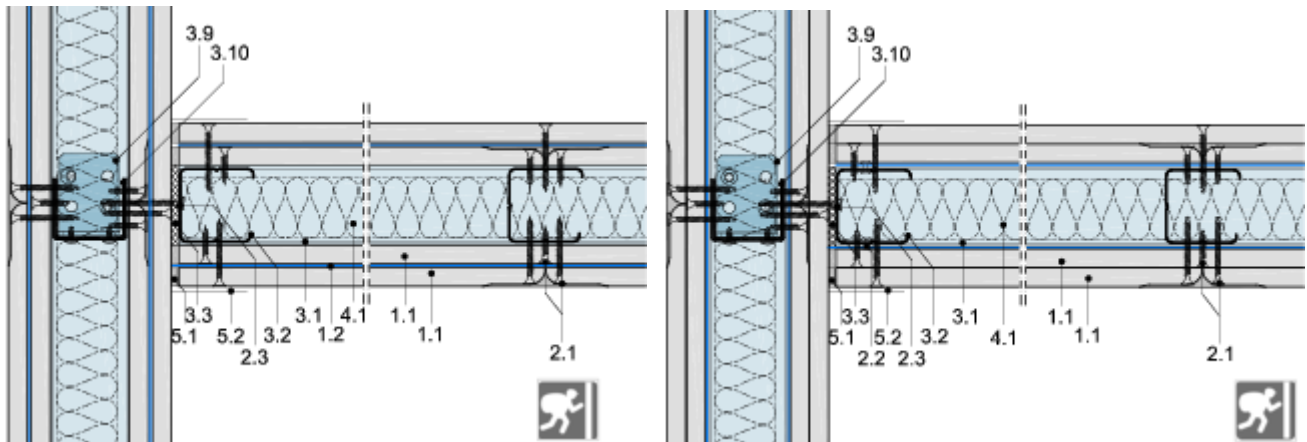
Wanddecke Doppelständerwand RC 2 mit erhöhtem Schallschutz
